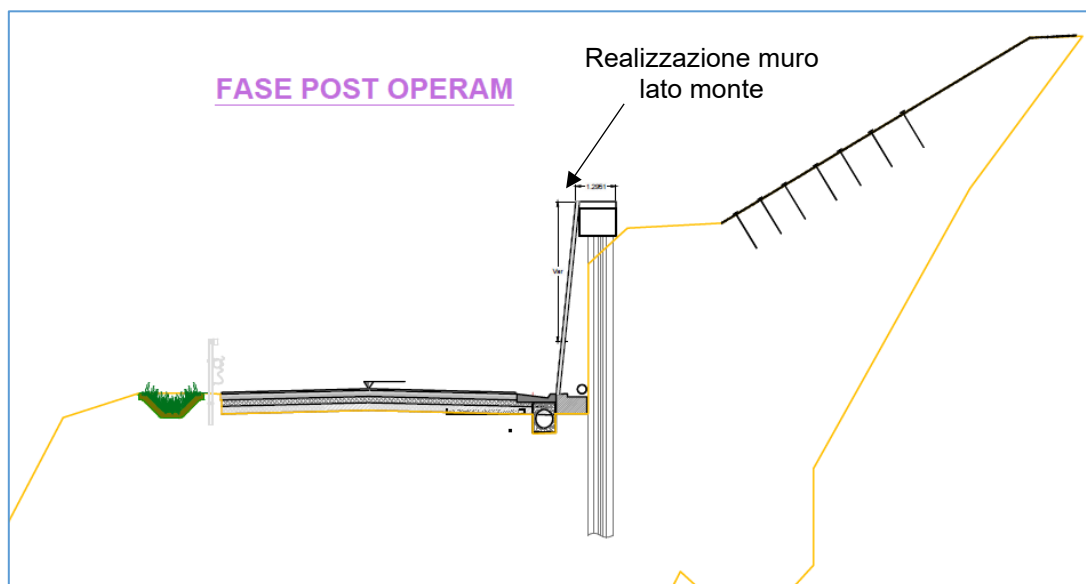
c – Sezione tipo 5 – Fase post operam
